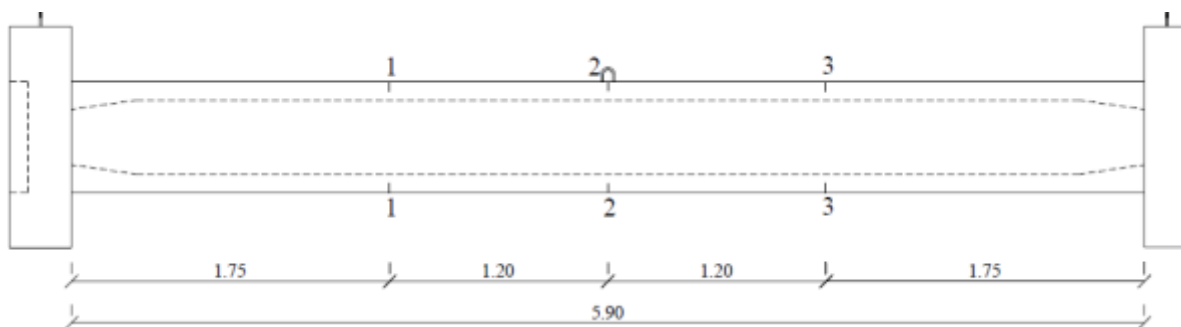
Esquema das secções onde foram colados extensómetros de resistência das armaduras [17]
